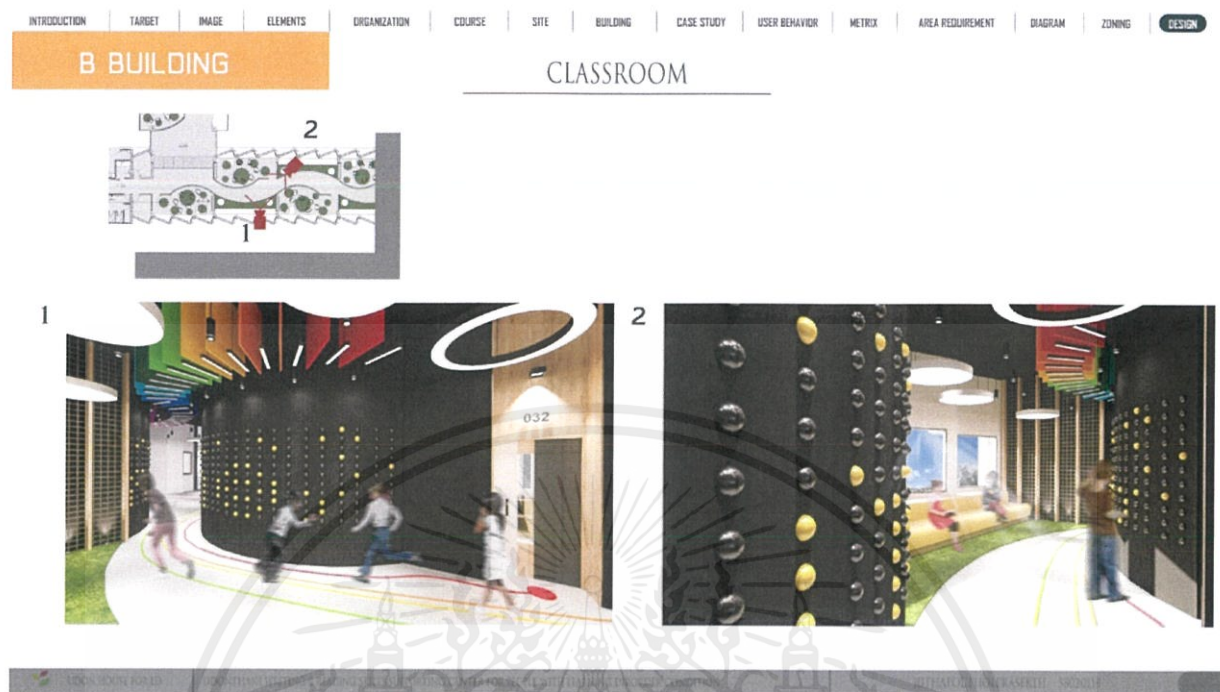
11 B BUILDING CLASSROOM
